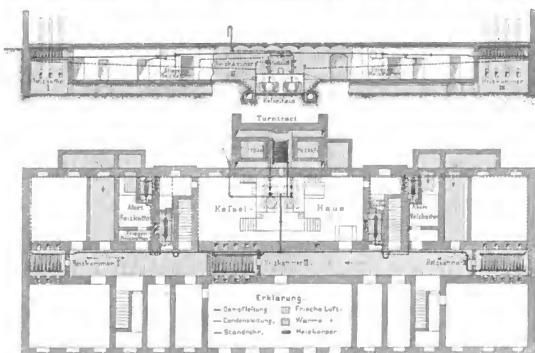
Längsschnitt und Grundriss der Schule V. Bez., Embelgasse.
